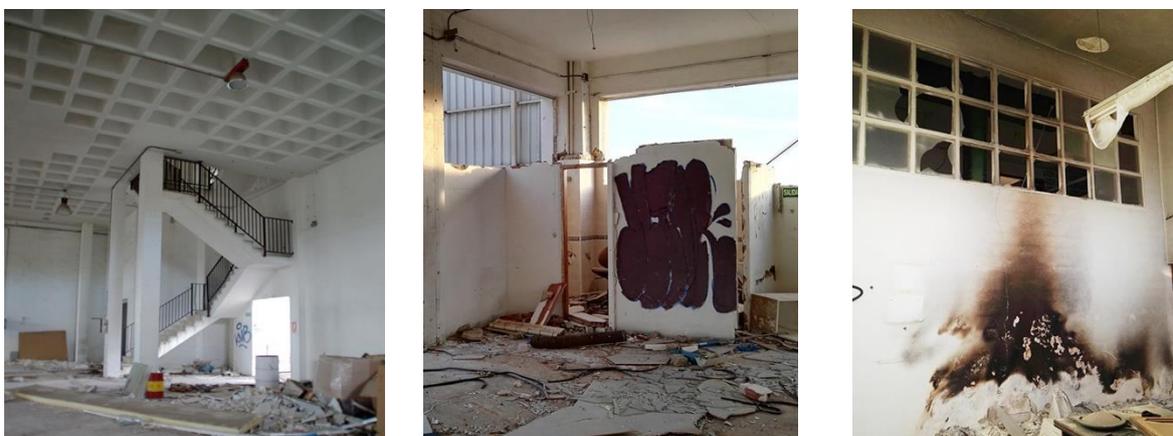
Imagen 1. Estado actual de la planta baja de la nave II. Imagen 2. Tabiques de los aseos de planta. Imagen 3. Daños por un pequeño incendio en la planta baja de la nave I. Fuente: autora.
